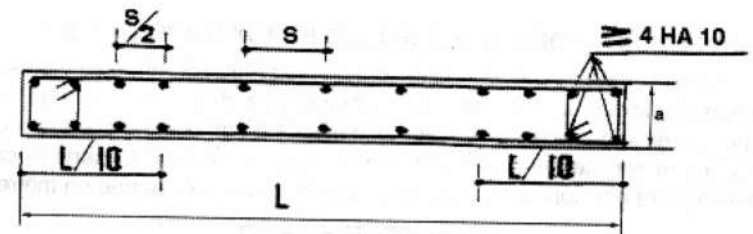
Disposition des armatures verticales dans les voiles
